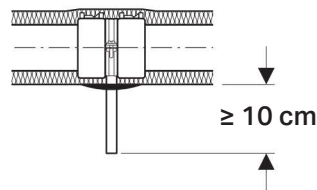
Detail Fixpunkt für einbetonierte Geberit Silent-db20 Leitungen
